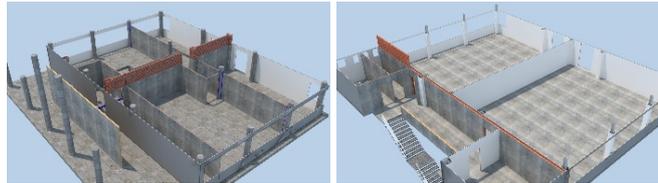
Animaciones de particiones existentes en el edificio. A la izquierda se observan las particiones modeladas en Planta Baja y a la derecha las de Planta Primera. (Elaboración propia, Allplan 2015).
